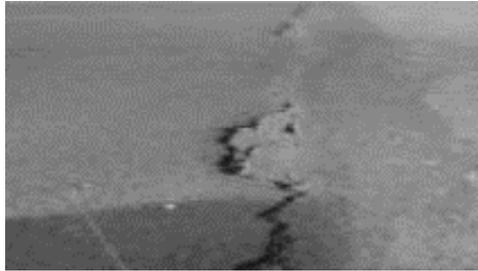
Fisuras reflejadas en la Calle 38, Cristo Rey.
